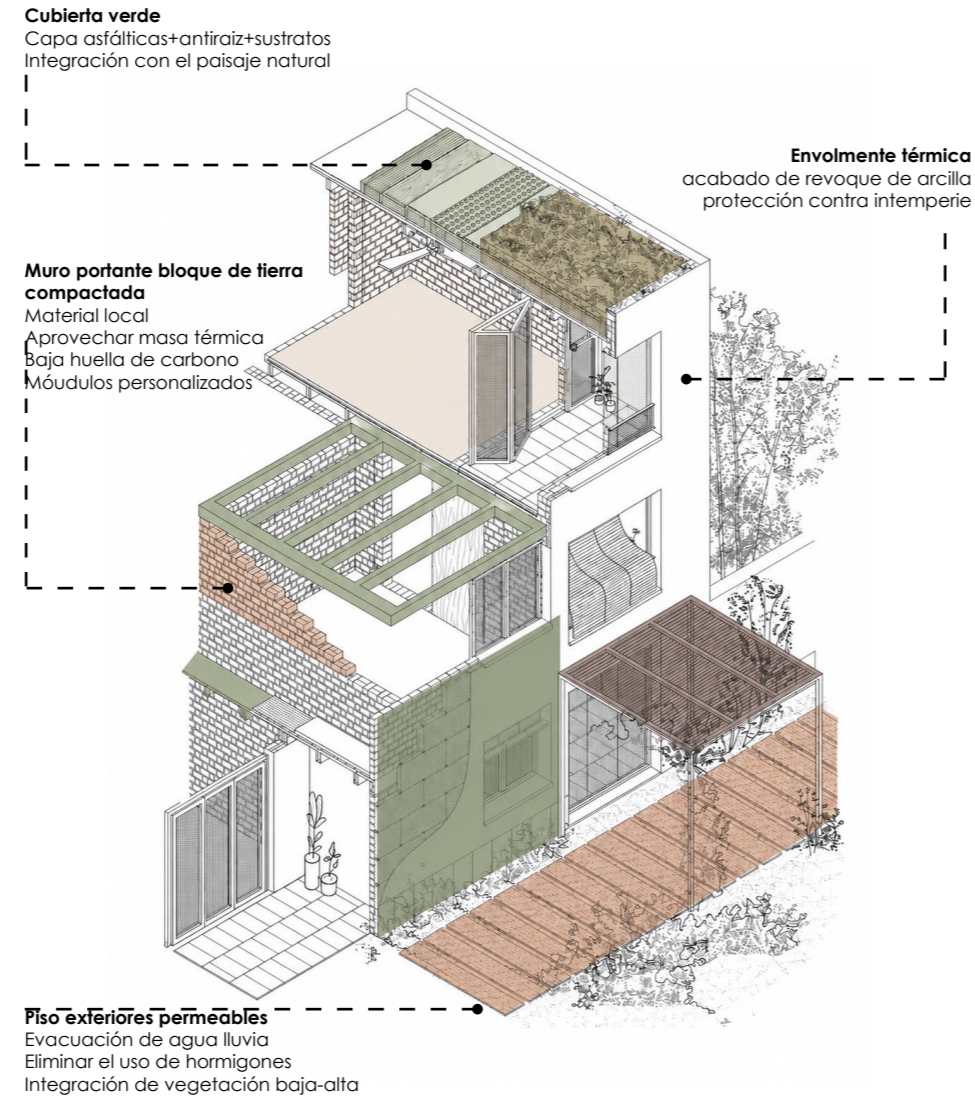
Esquema constructivo. Fuente: Peris Toral. Elaboración propia.
